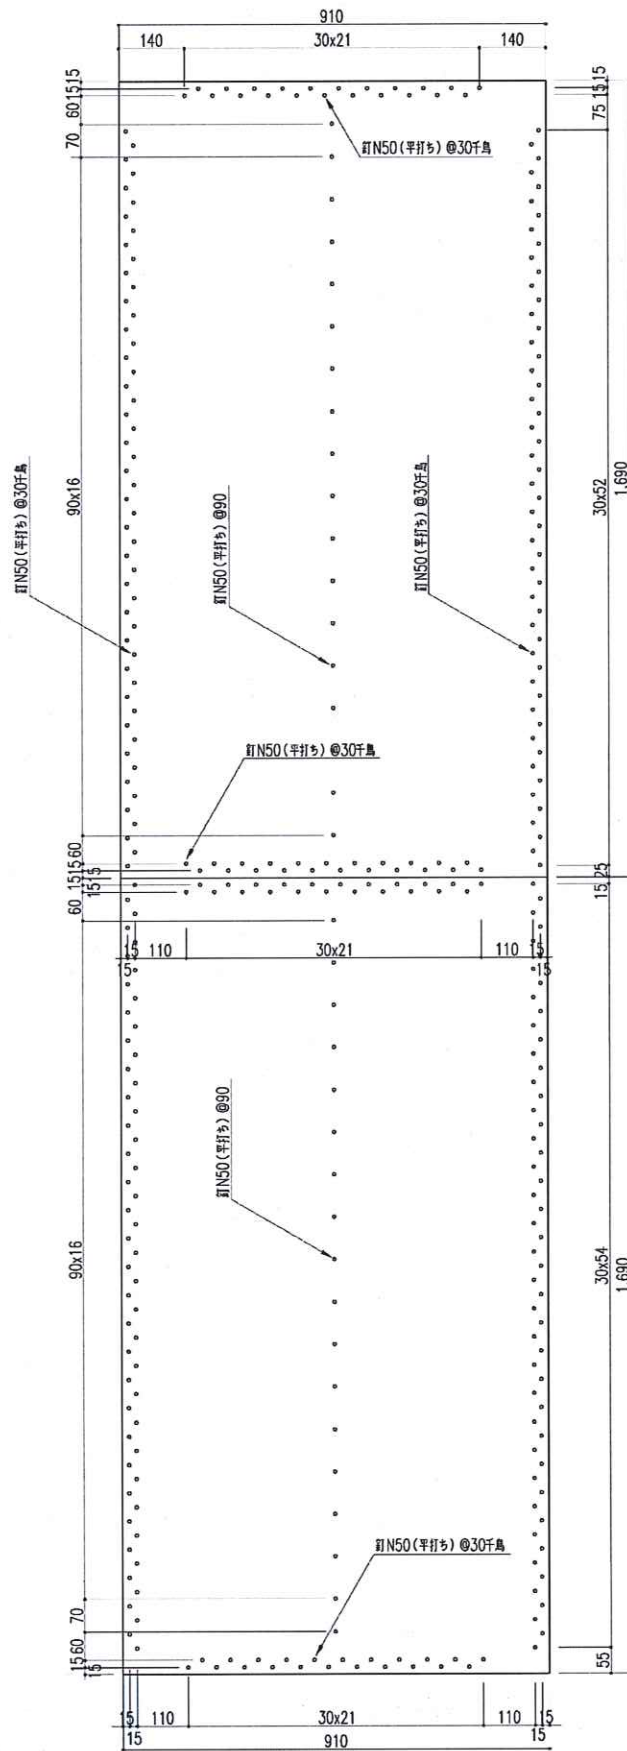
面材釘配置図 (試験法 A・B 共通) (単位: mm)
